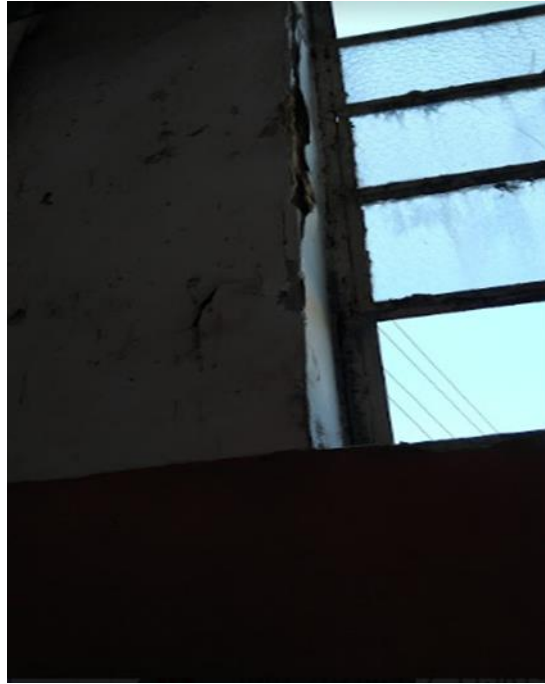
Paredes com infiltrações e estrutura necessitando de reparos urgentes
